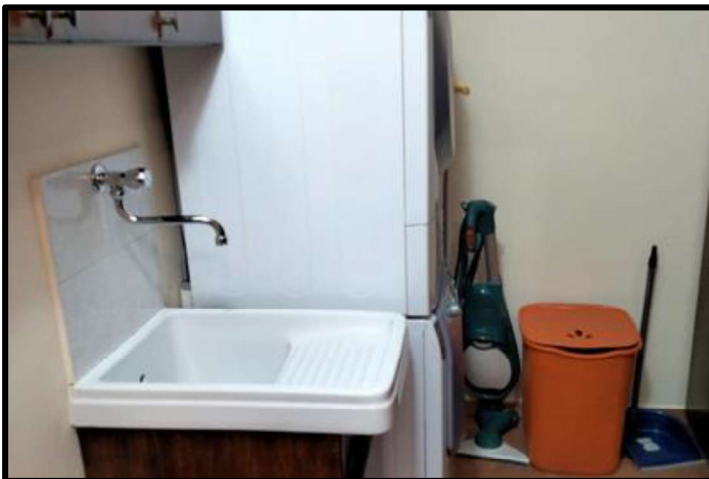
Vista interna del ripostiglio – lavanderia.
